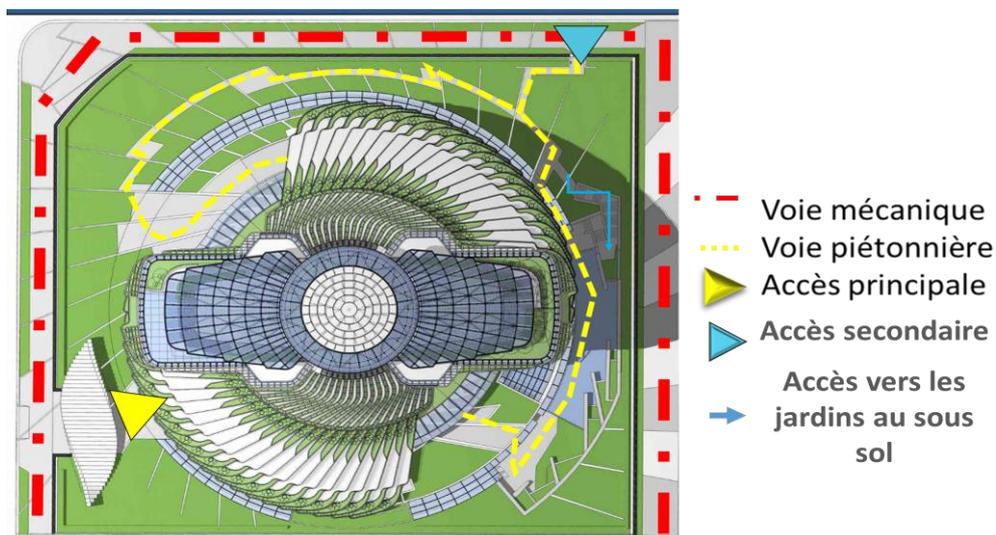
plan de masse. (Source : Vincent Callebaut Architectures)
